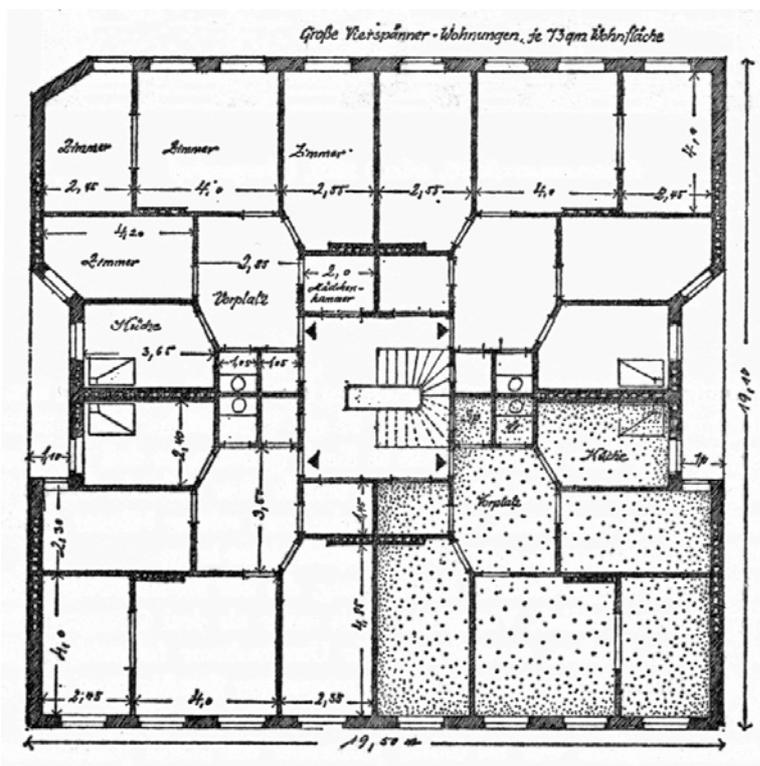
Typischer H-Grundriss aus Funke, S. 53
